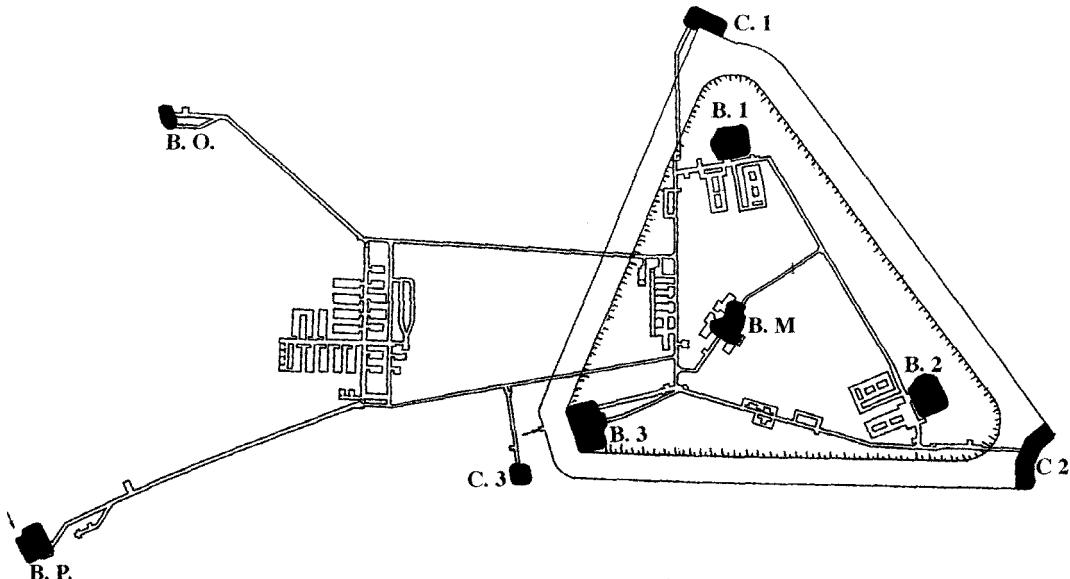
Plan du fort d'Aubin-Neufchâteau⁶⁰
